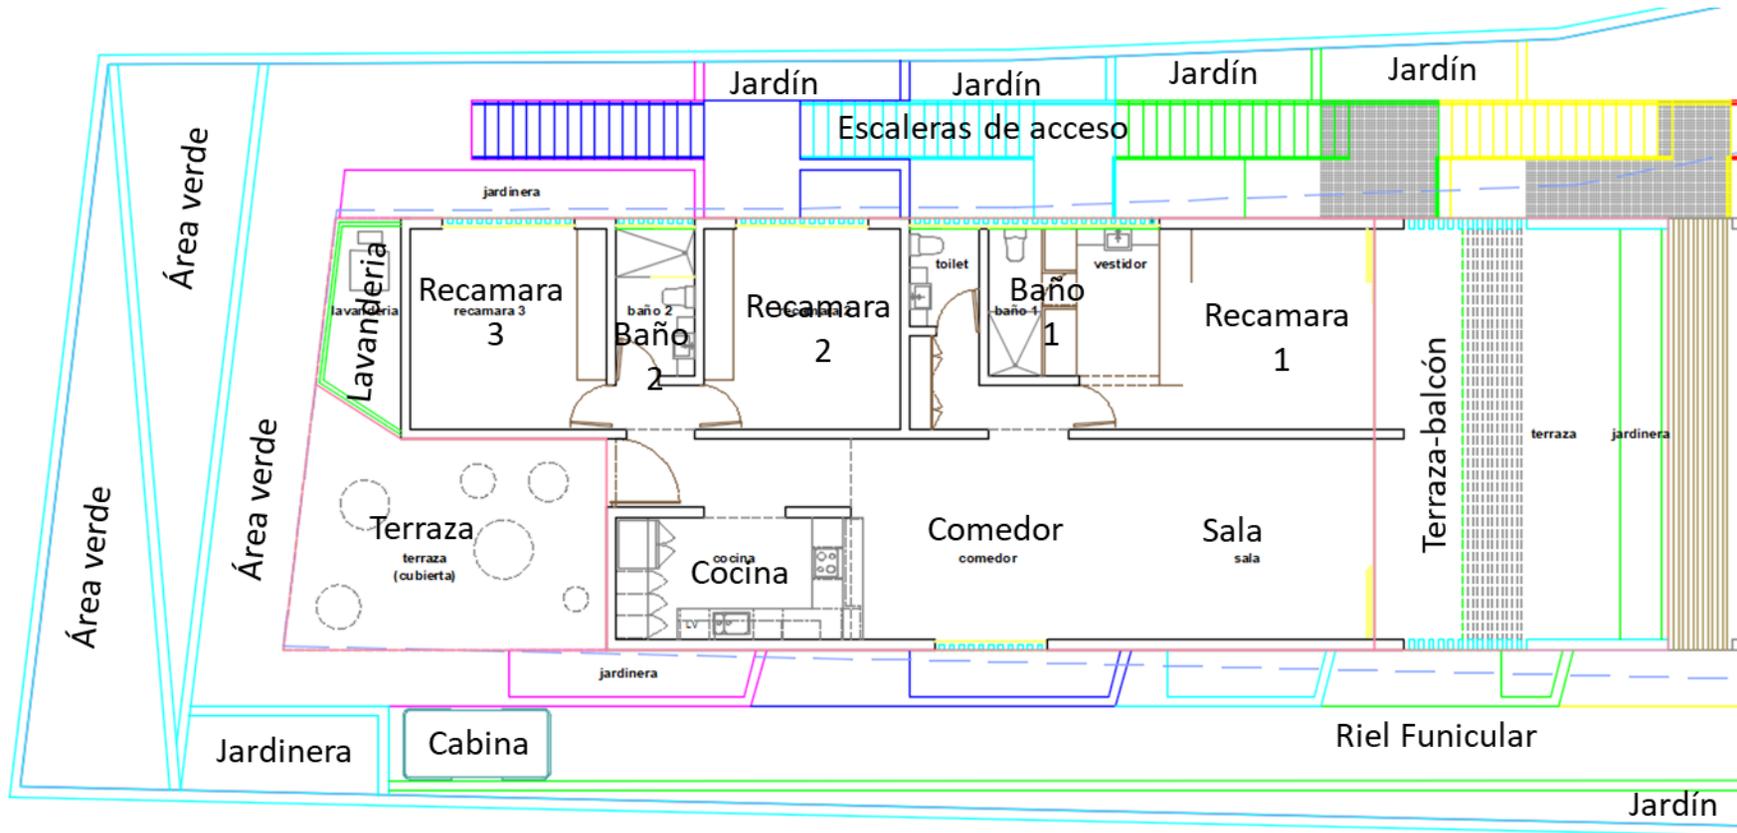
PLANTA TIPO NIVELES 1 AL 5
